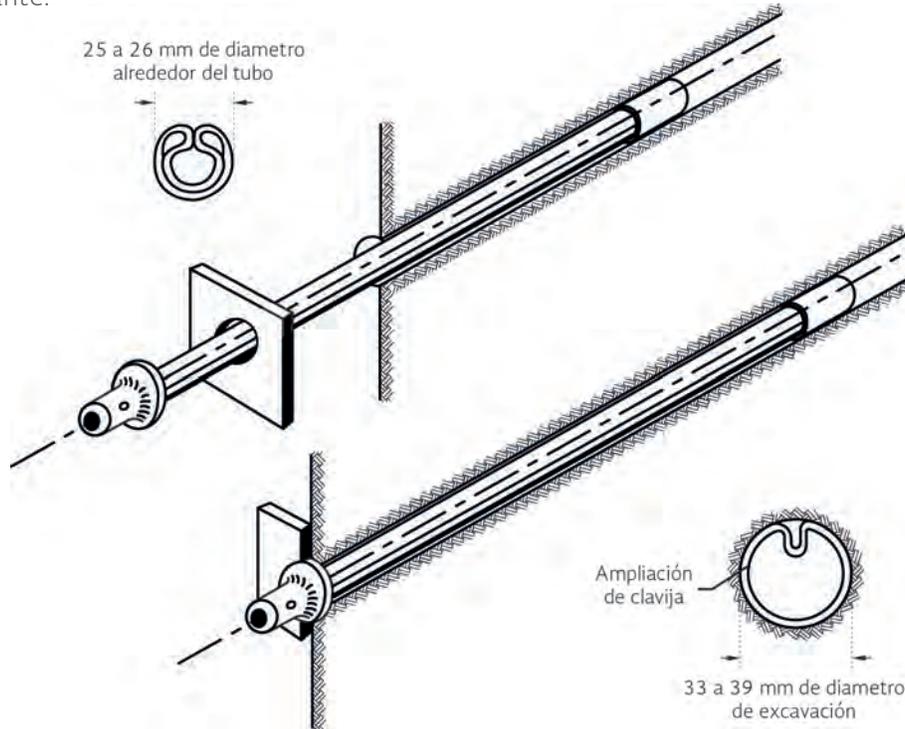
Anclajes de fricción tipo Swellex. Tomado de E. Hoek (2000).
